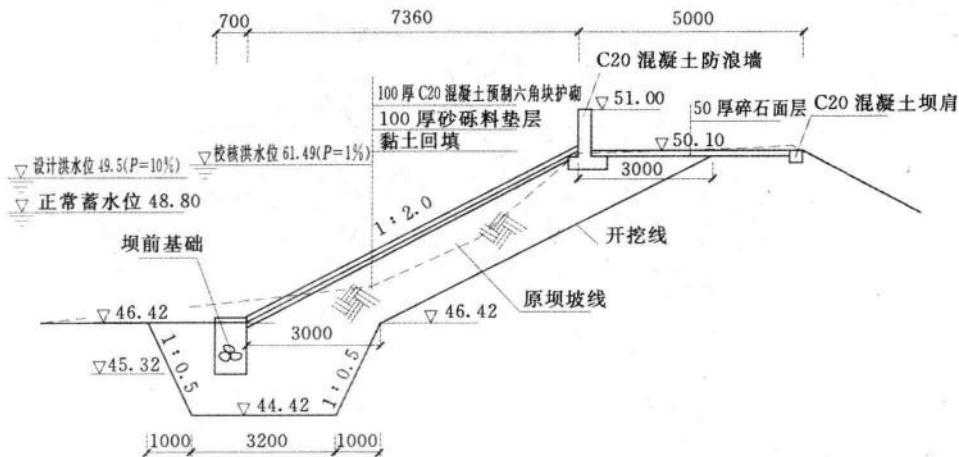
黏土斜墙断面图 (单位: 高程 m; 尺寸 mm)
